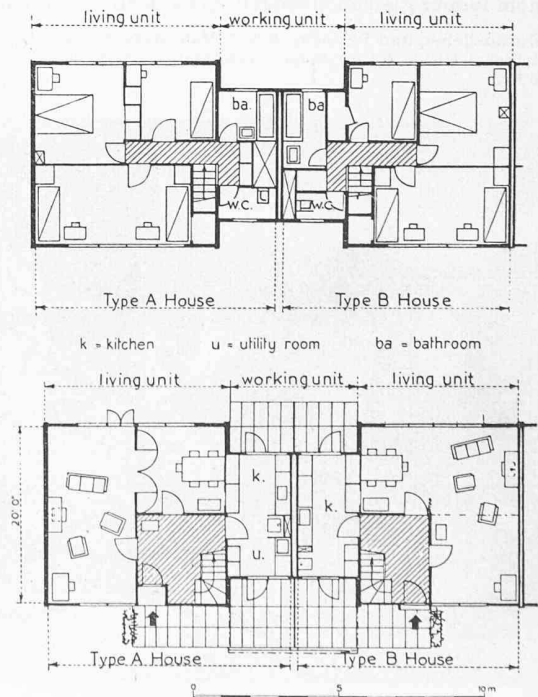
Howard-Haus, Erdgeschoss und Obergeschoss 1 : 250. Utility room = Putz-, Heiz-, Wasch- und Abstellraum
